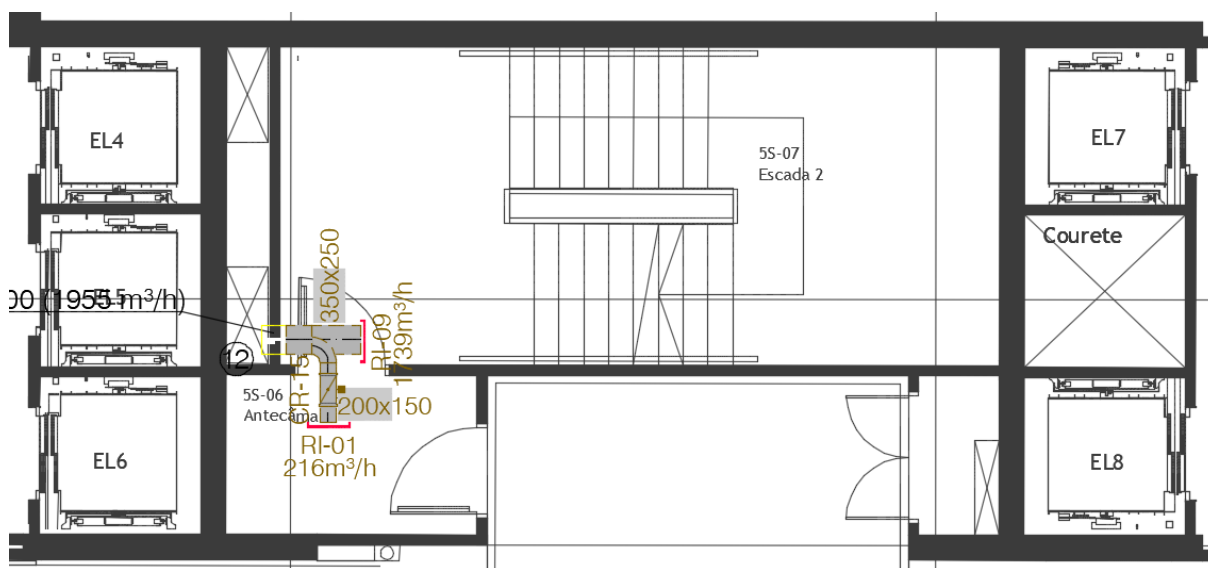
Caixa de escada 2, em planta, do piso -5 – HCD Expansão
